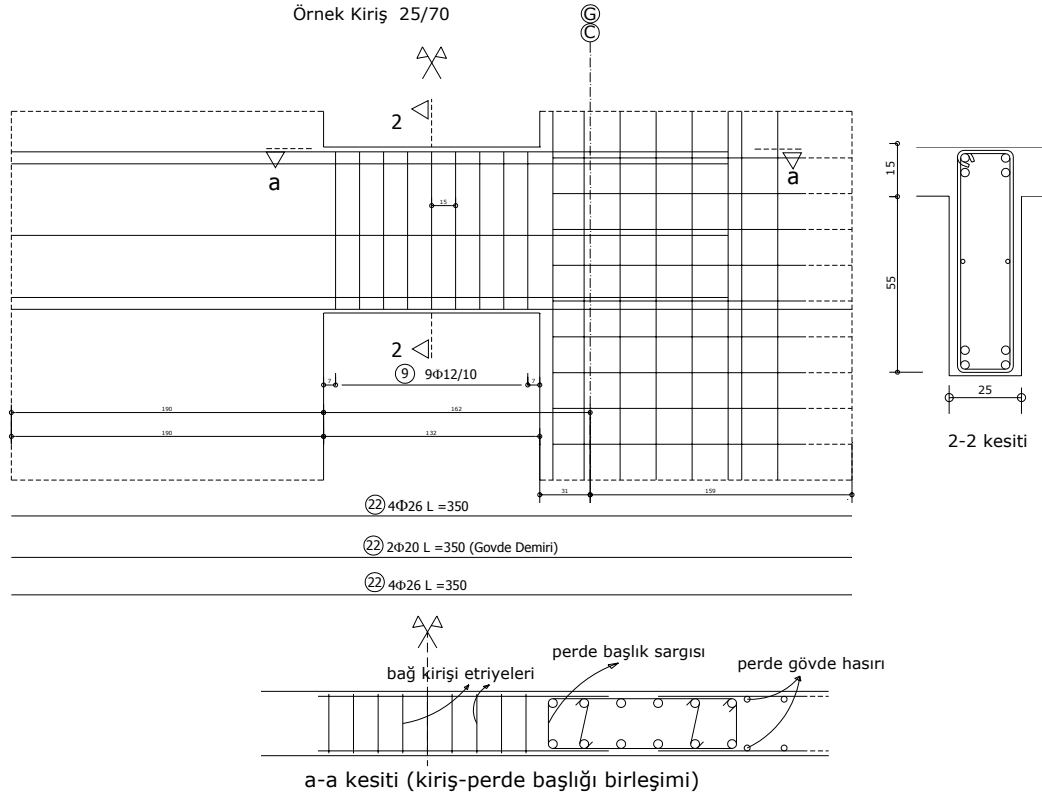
Perde donatı detayı; kesitleri ve plan
